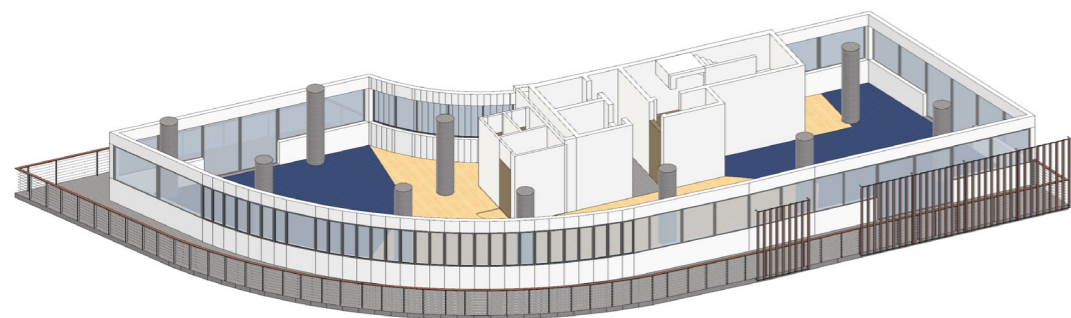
Perspectiva do pavimento tipo da Torre 2.
